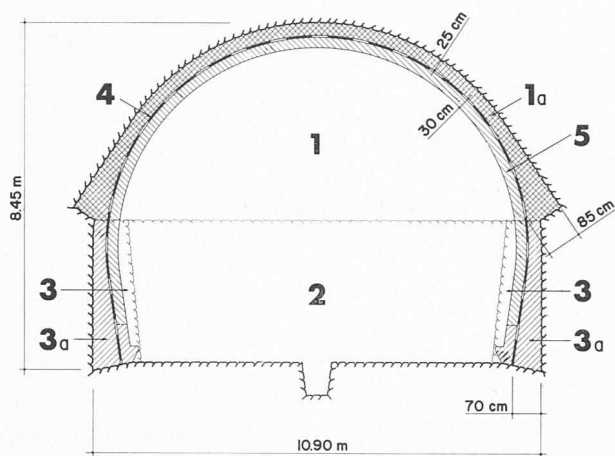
Profil du tunnel du Flonzaley : schéma d'excavation et de bétonnage.
